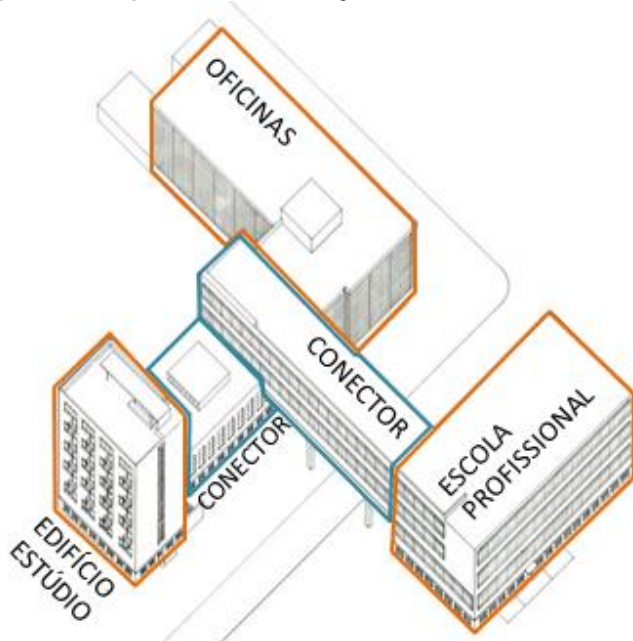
O conjunto construído da escola Bauhaus Dessau.
